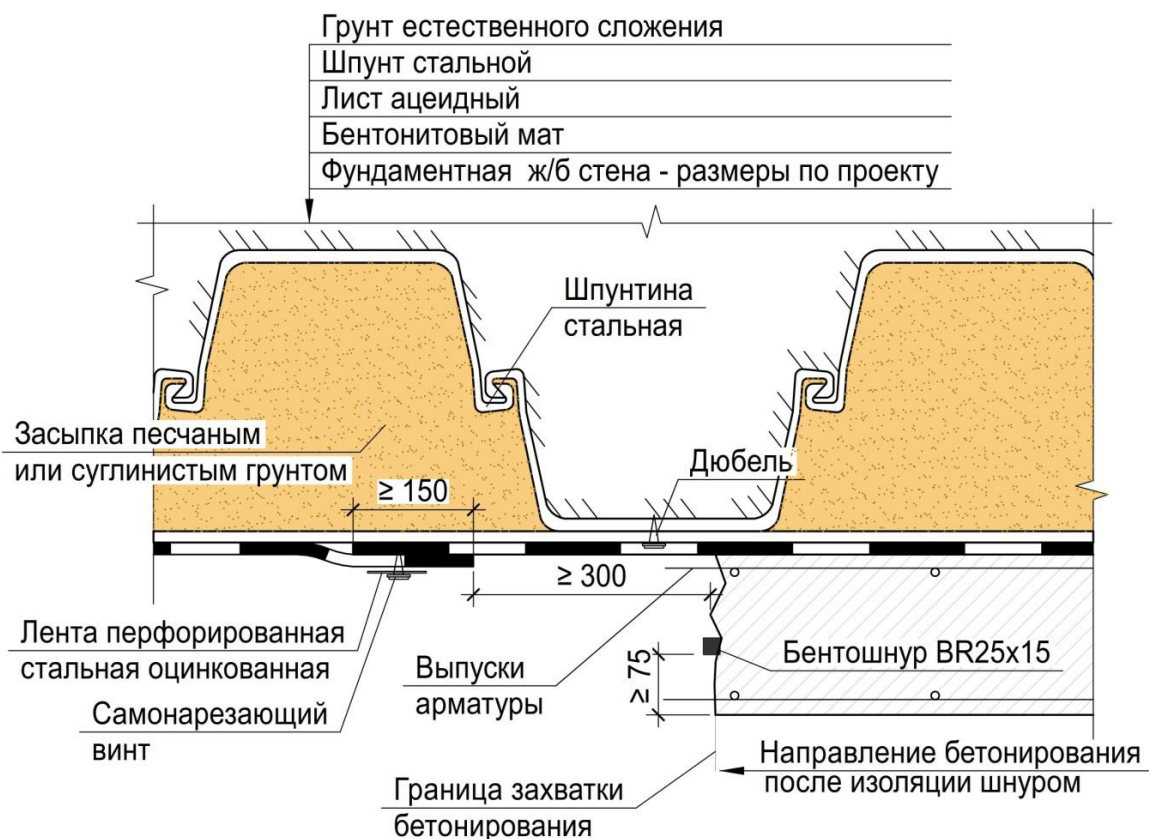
Узел устройства изоляции крепи котлована шпунтовой стенкой
